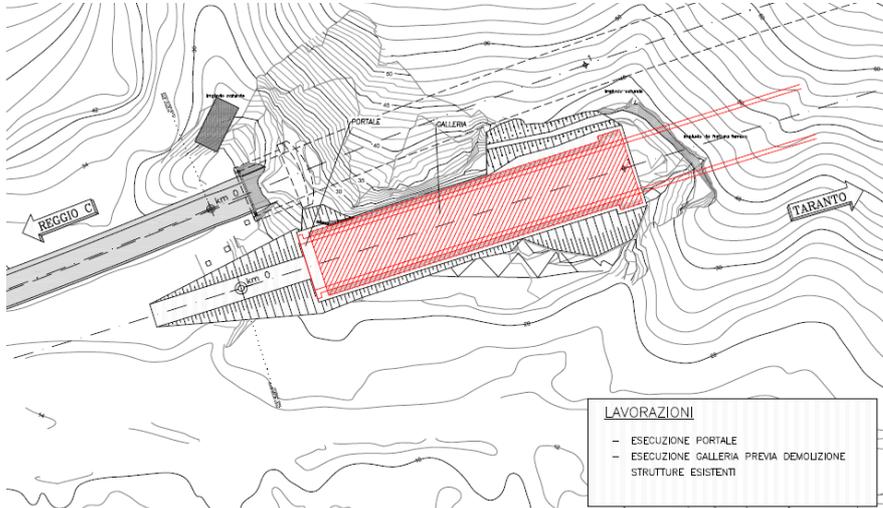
Galleria Palizzi – Fase 2 – Lato RC
